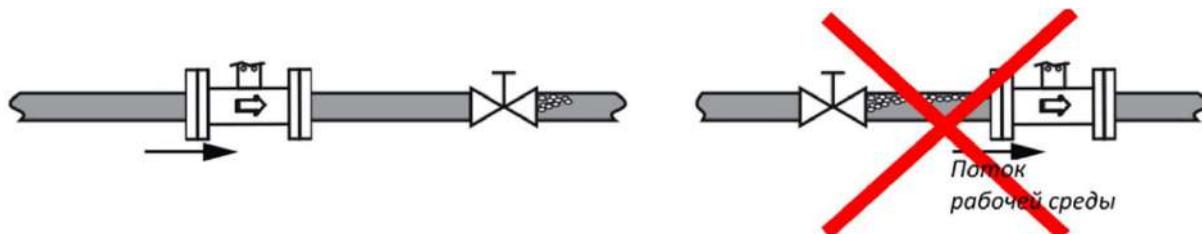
Монтаж расходомера с трубопроводной арматурой
